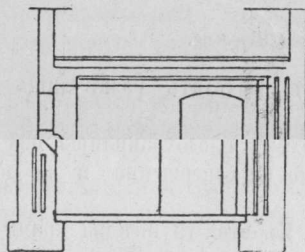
Поперечный разрѣзъ плодохранилища Штольце.
